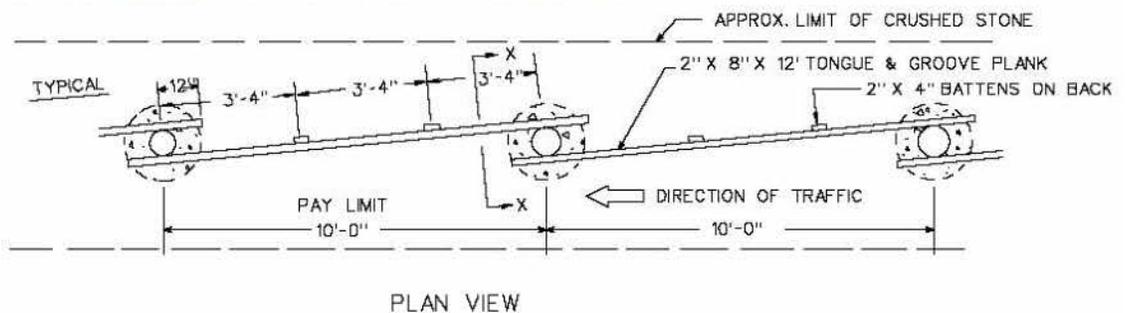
vue de plan du mur de bois développé par le Connecticut D.O.T.
